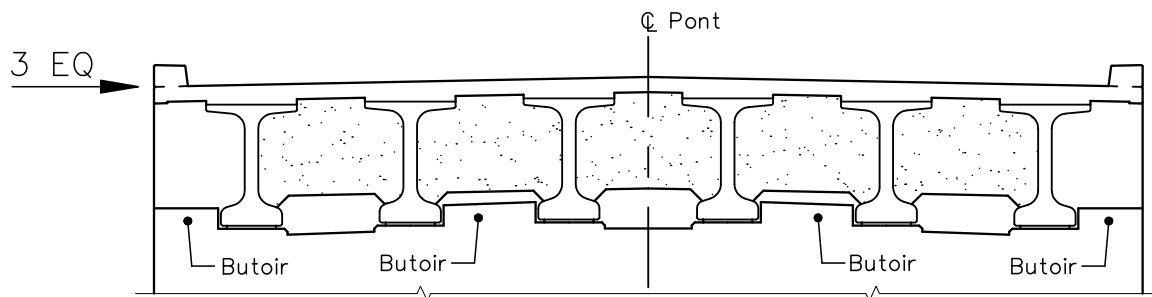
Diaphragme sur pile – Tablier continu
